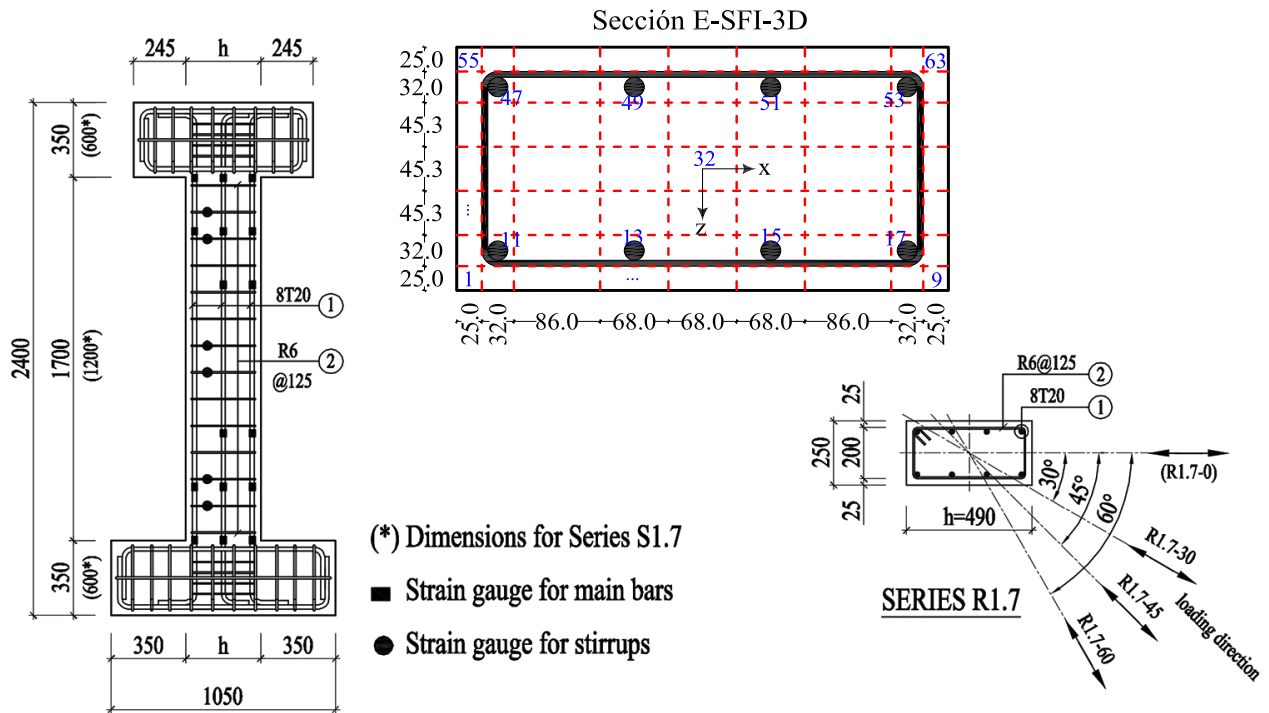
Configuración de las columnas de [Tran and Li, 2012] y [Pham and Li, 2013], y discretización transversal para el modelo E-SFI-3D.
